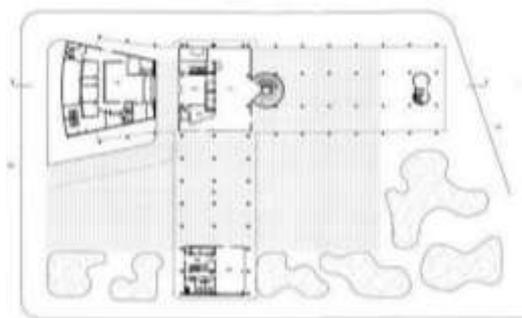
Ministério da Educação e Saúde, RJ – Lúcio Costa e equipe, 1937-43. Planta baixa pavimento térreo.
